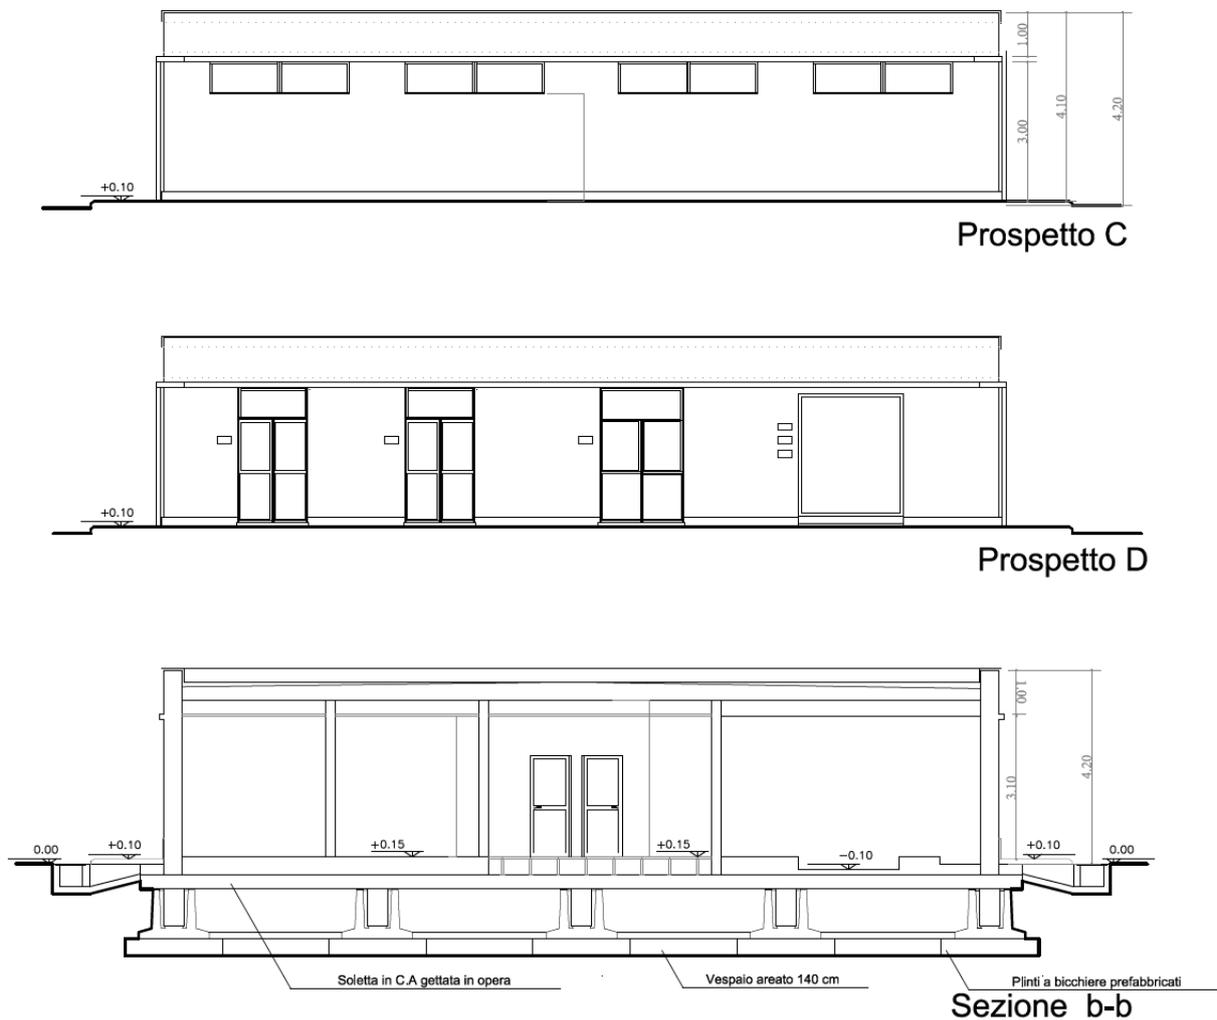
Prospetti C, D e sezione b-b dell'edificio servizi ausiliari.
